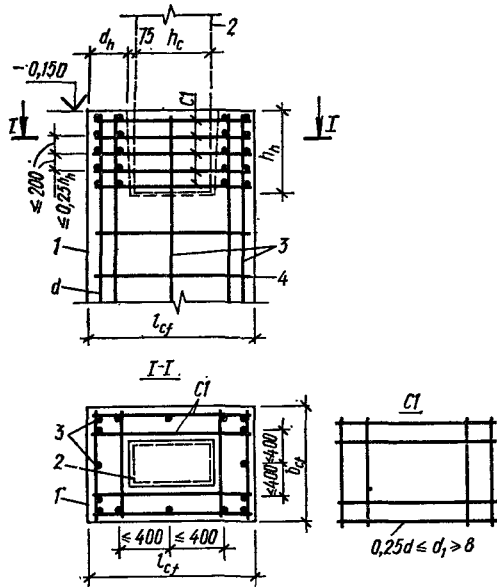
Армирование стаканной части фундамента сборной колонны сварными сетками (С1):
